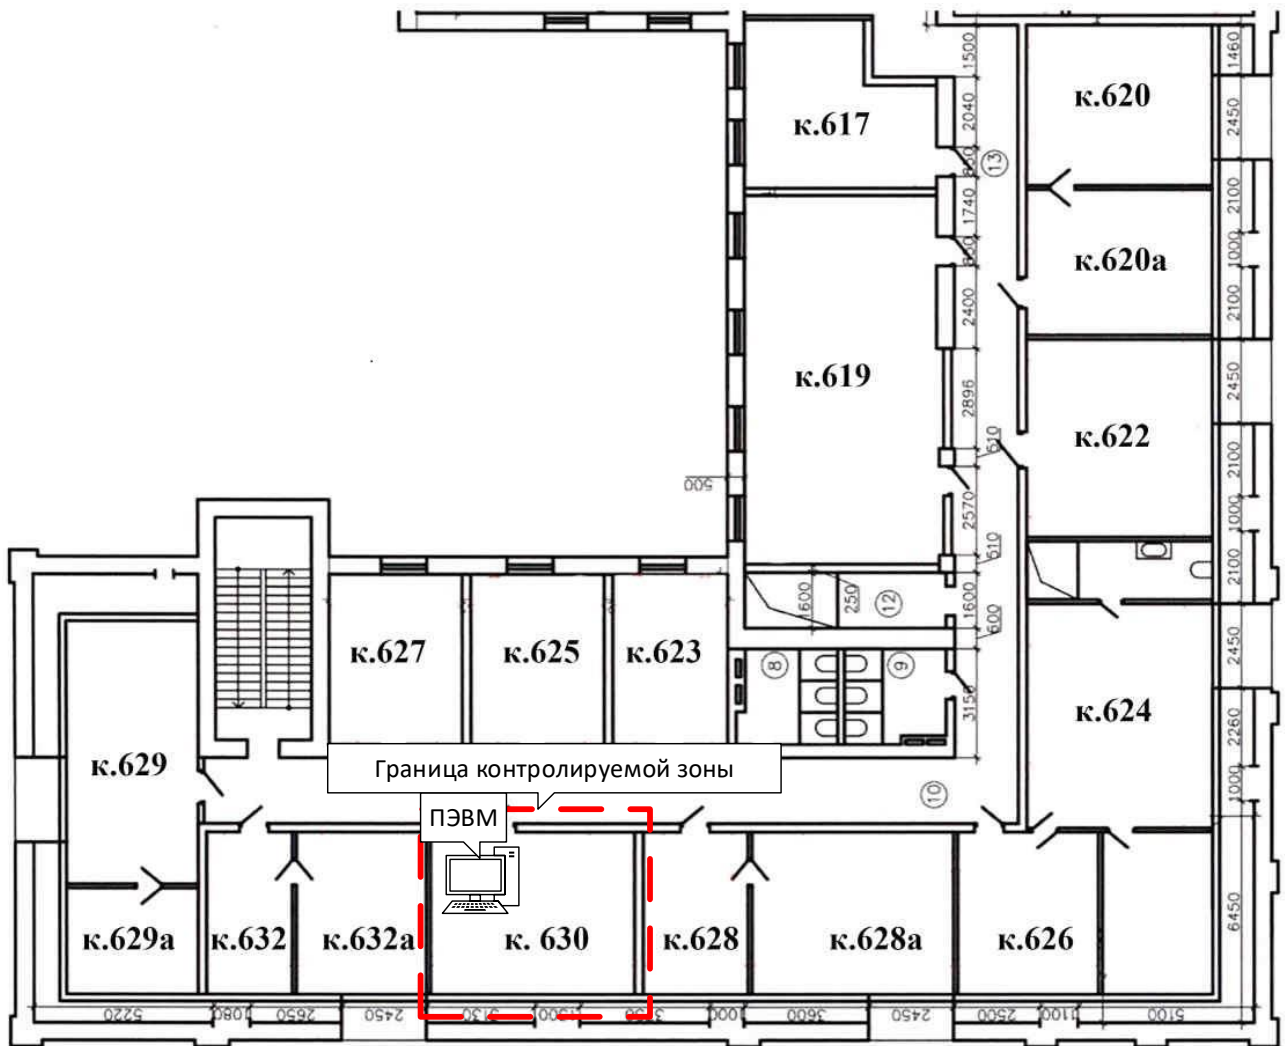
Схема расположения АРМ ИСПДн 6-го этажа по адресу: г. Москва, Котельническая набережная д.17
